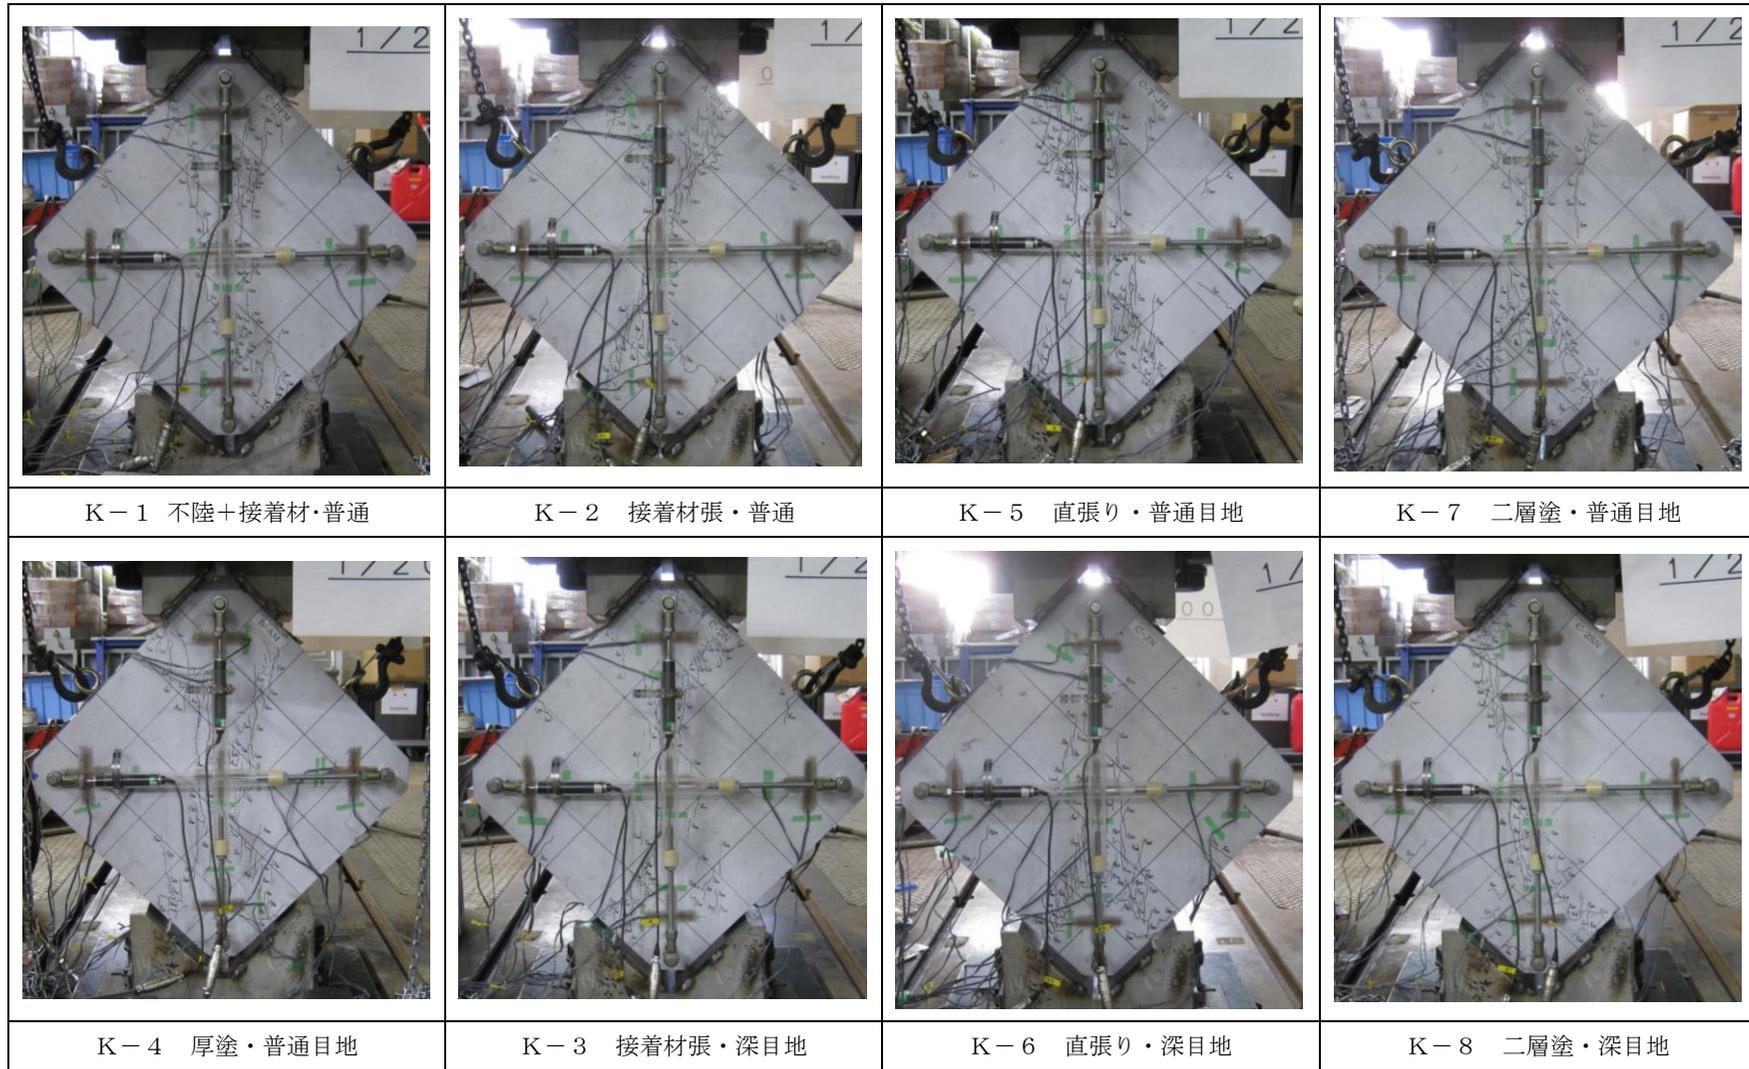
セン断変形角 1/200 時の解放型治具によるダイアゴナル試験のコンクリート基盤の破壊状況
